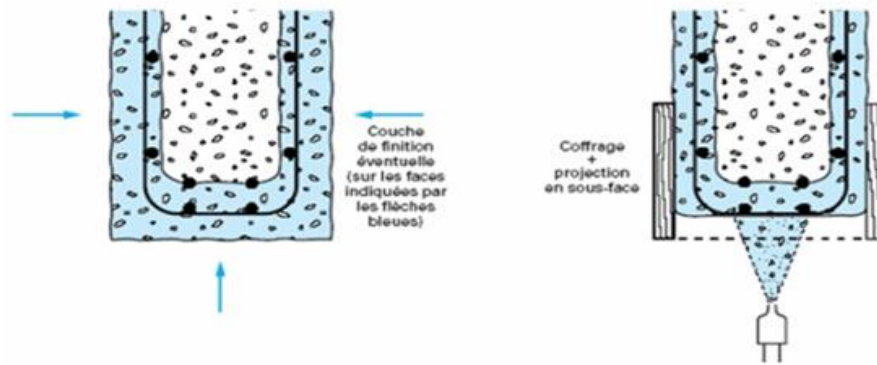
Réparation de poutre par béton projeté. [(Resse C, Venaut M). 1981]
